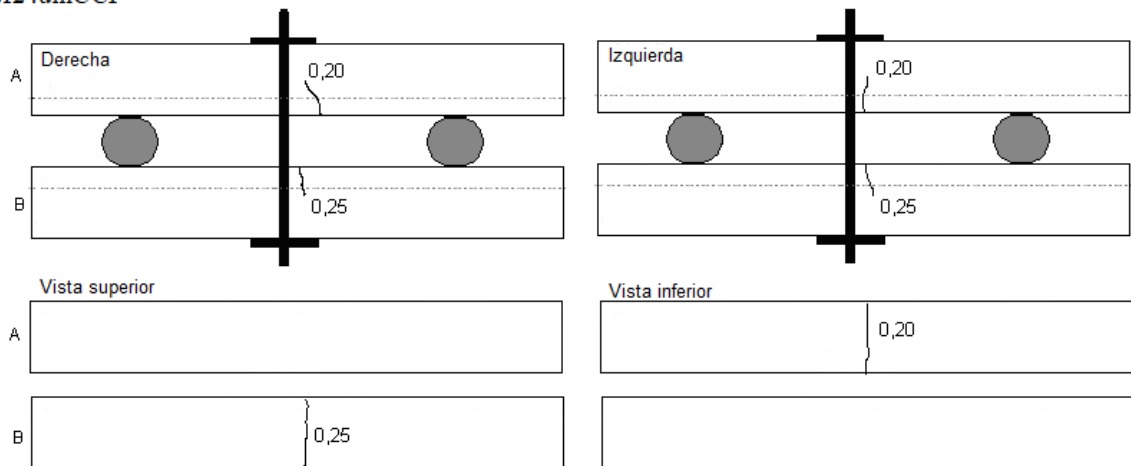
Mapeo de fisuras en modelos de hormigón que ha estado bajo carga central permanente durante 24 meses (M24umCCP).
